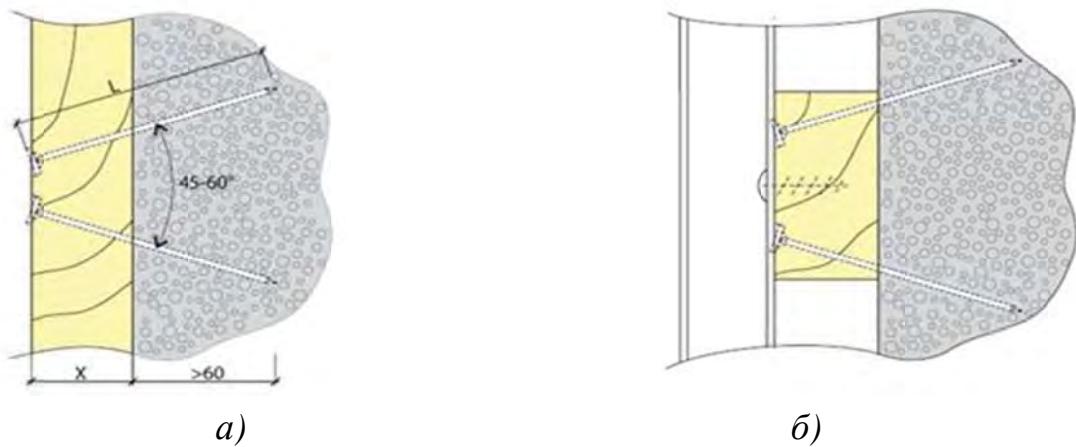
Гвоздевое крепление обрешетки: *а* — деревянный брускок, набитый на кладку непосредственно; *б* — крепление профиля через опорный брускок
